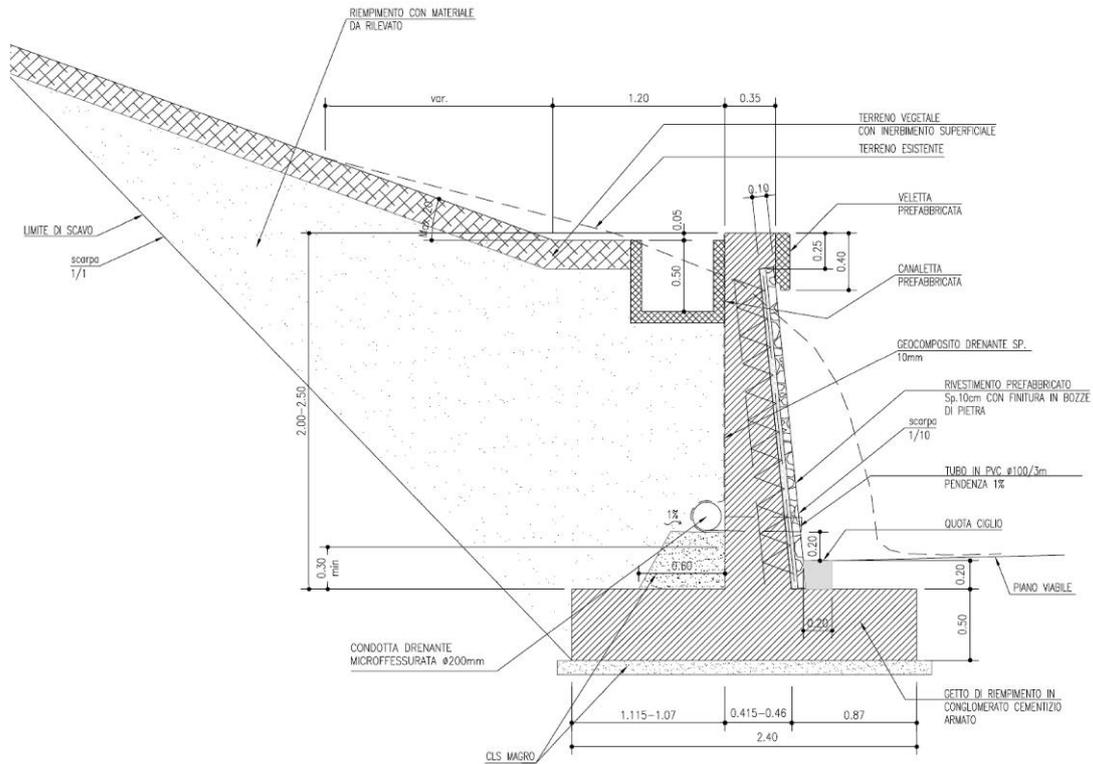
Sezione trasversale muro di controripa MC201 - H = 2.0/2.5 m
